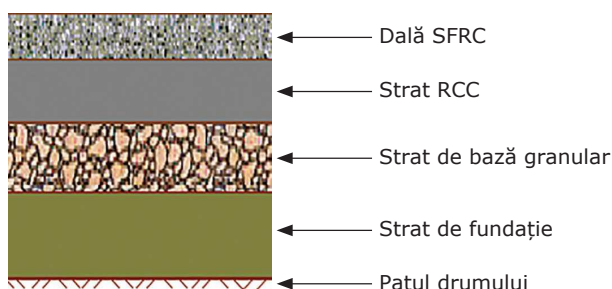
Opțiunea B2 – Dală din beton armat cu fibre din oțel (SFRC) ca și strat de uzură și de bază, având diferite procente de armare, așternute pe un strat sub-bază stabilizat cu ciment sau cu rezistențe scăzute
